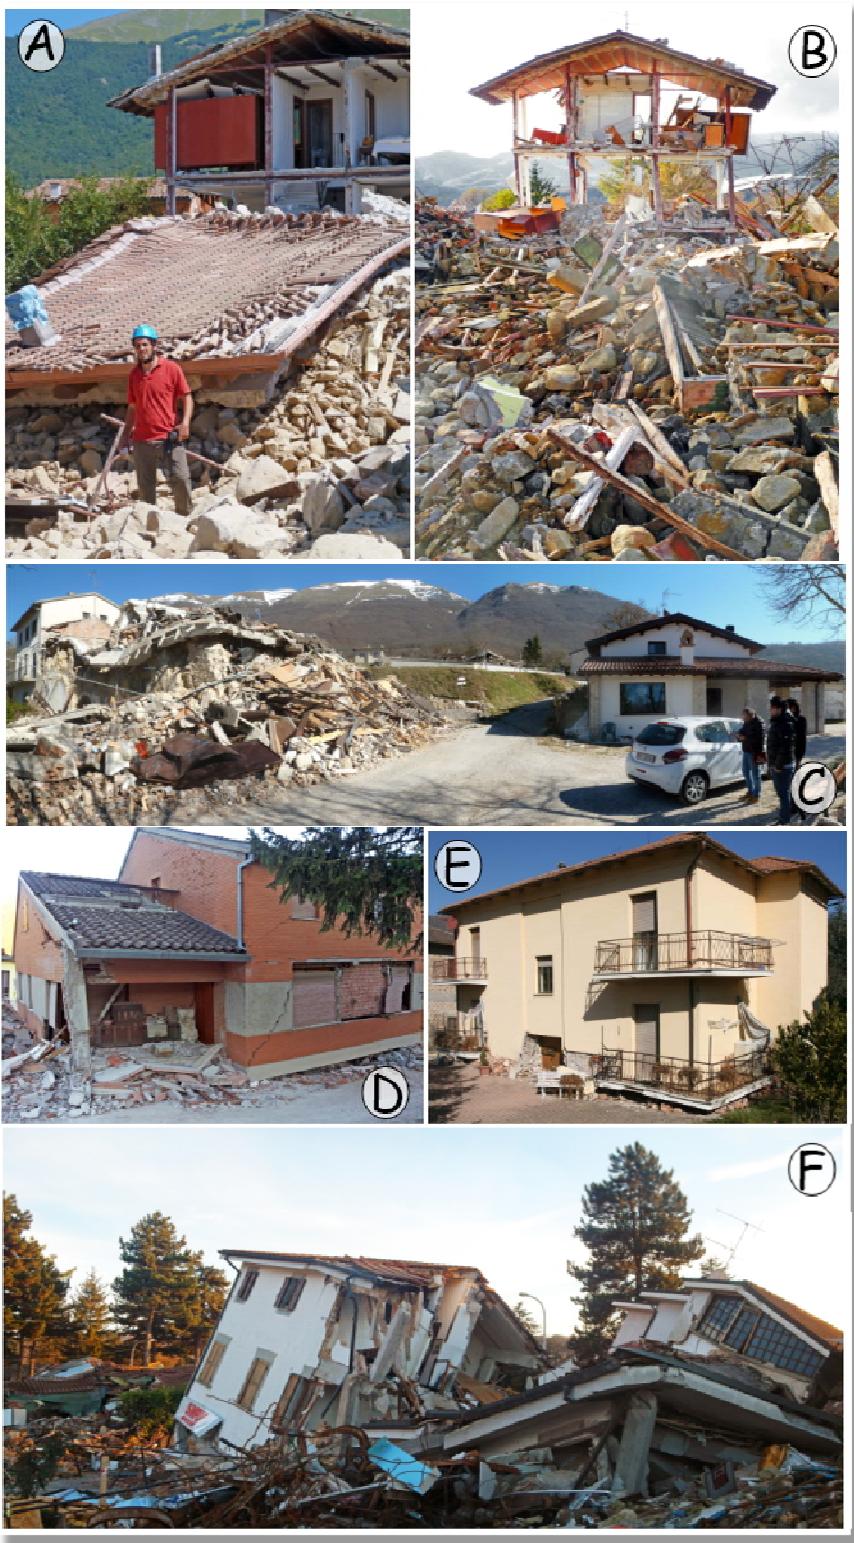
Differenti tipologie di danno. A, edificio in pietra (Petrana, Amatrice) crollato sotto il peso del pesante tetto in cemento armato. In secondo piano, porzione della stessa casa rinforzata da un telaio in acciaio (foto del 25 Agosto); B, stessa casa dopo il terremoto del 30 Ottobre, con il solo scheletro in acciaio ancora in piedi. C, confronto tra il comportamento di un edificio recente in muratura portante in Poroton® (destra) e una casa in pietra restaurata di recente con cordoli in C.A. e catene in acciaio (campagna di Norcia). Schiacciamento del piano soffice in un edificio in C.A. (D) ed in uno in muratura (E) a Norcia. F, crollo di edifici in C.A. ad Amatrice, entrambi apparentemente integri dopo il terremoto del 24 Agosto.
